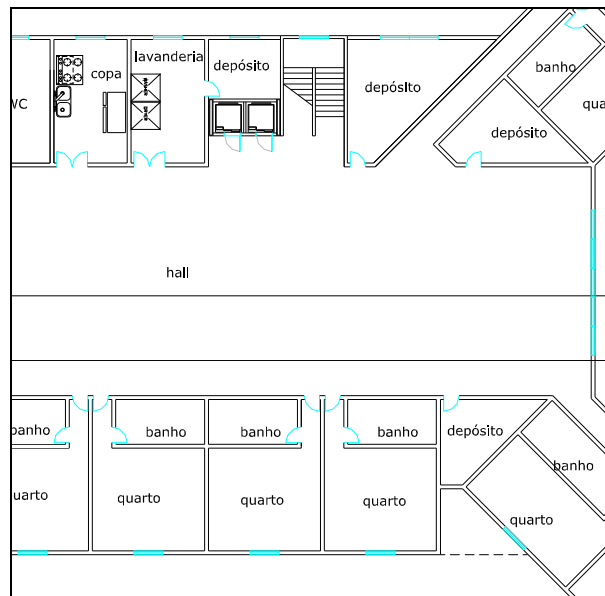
Área de acesso aos dormitórios 2º pavimento do Projeto “B” : dimensões extensas (s/esc.).
